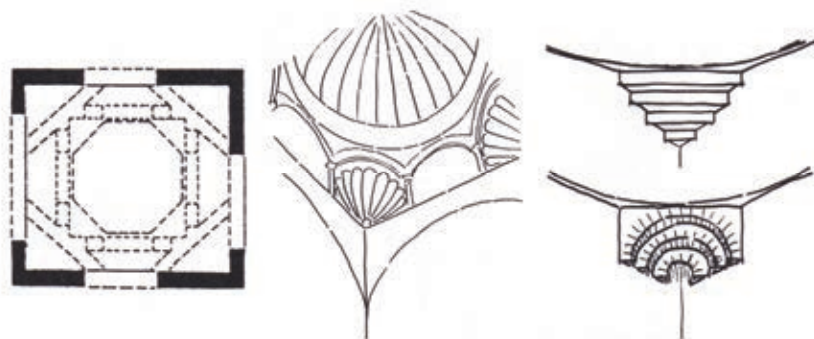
Übergänge zwischen dem viereckigen Raumgrundriss und der kreisrunden Kuppelbasis. – Balken im 45°-Winkel; Trompen; auskragende Ziegellagen.
